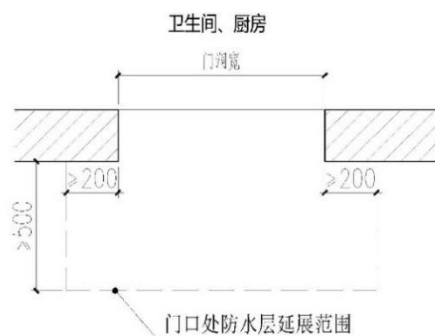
卫生间楼地面门口处防水层延展示意图
